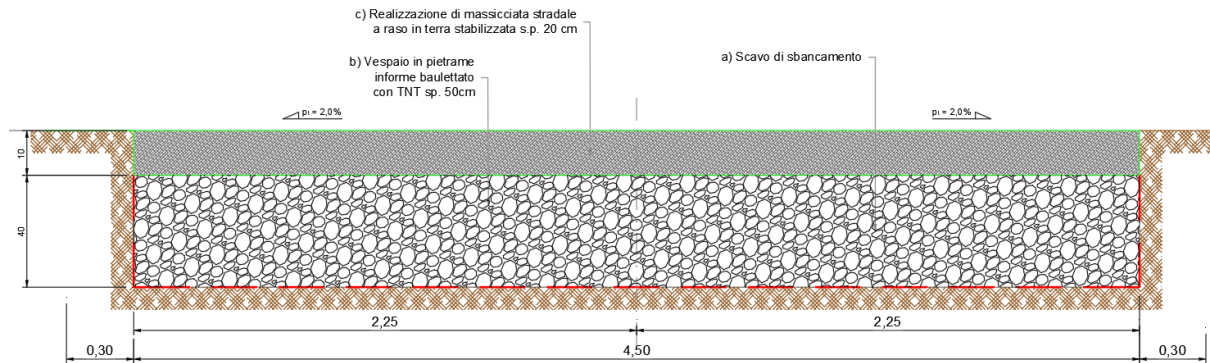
Sezione stradale drenante di progetto verso l'aerogeneratore PR15
